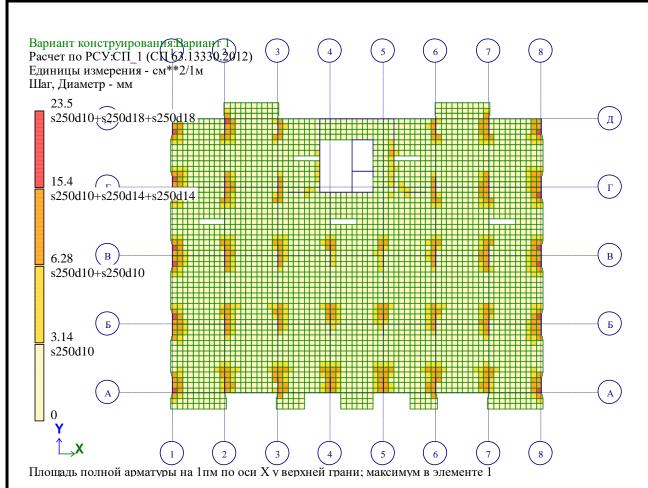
Расчетное армирование плиты над первым этажом по оси X у верхней грани.
